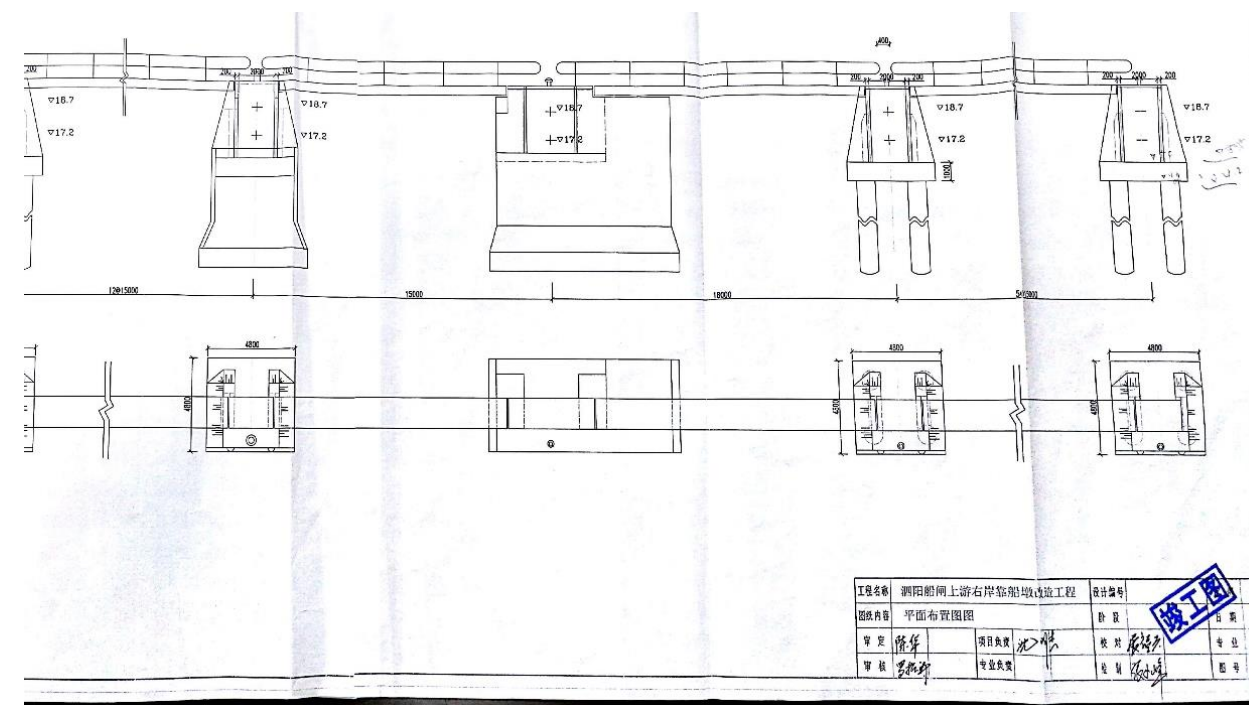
一号船闸上游靠船墩平面布置图 (16#~21#)
